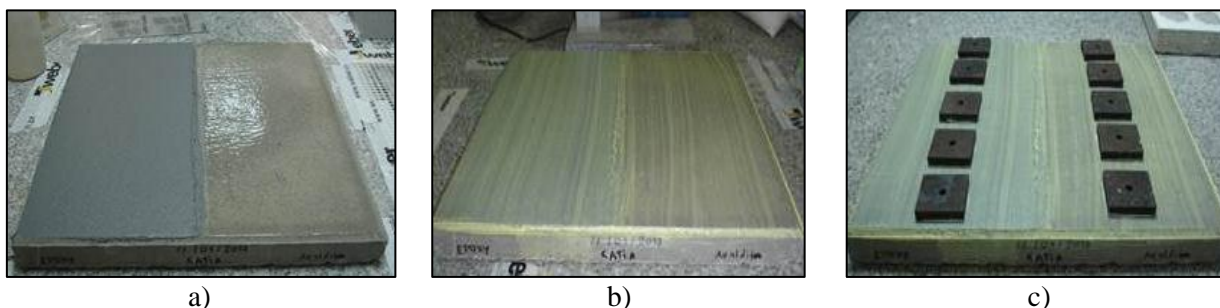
Ensaio para avaliação de ações de ligação entre colas: a) Placa de betão após aplicação de RE.1 e CE; b) Após aplicação de PAD.1; c) Após colagem dos discos de tração.
